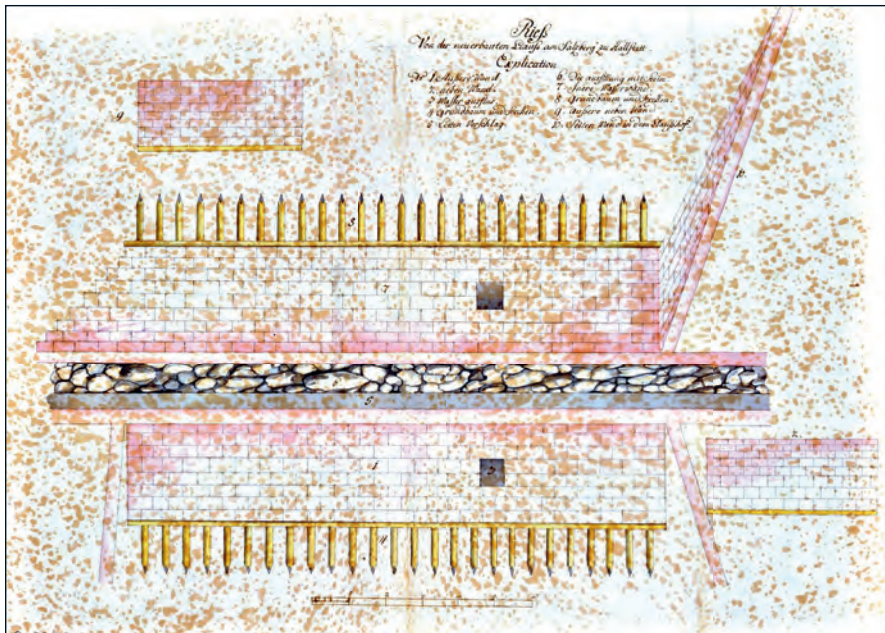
Pfahlgründung einer Klause aus Quadermauerwerk (Hofkammerarchiv Wien, Sign. Qa 72/13).
